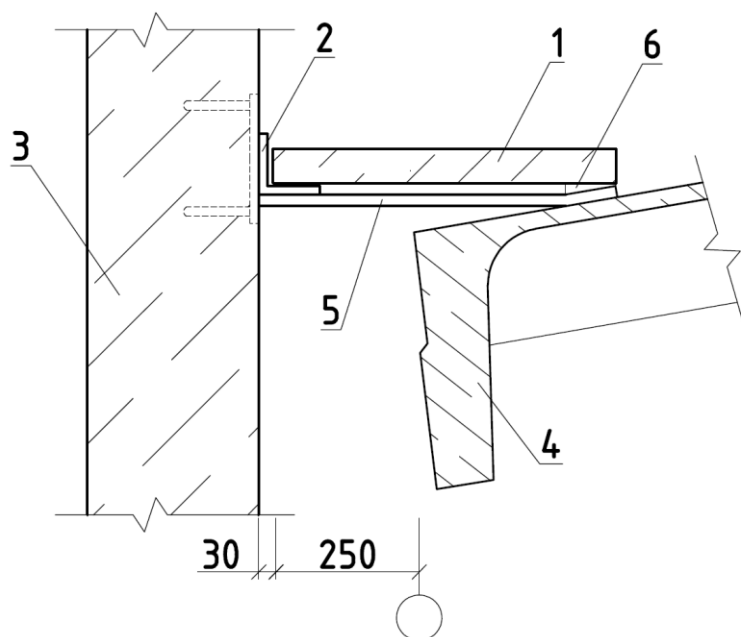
Установка доборных плит покрытия при привязке колонн каркаса "250" и скатной кровле: 1 - доборная плита покрытия (см. таблицу 5); 2 - стальной уголок 100x100x8 (приварить к закладной детали стеновой панели); 3 - парапетная панель; 4 - железобетонная ребристая плита покрытия; 5 - деталь крепления стеновой панели (стержень диаметром 10 мм); 6 - цементно-песчаный раствор
